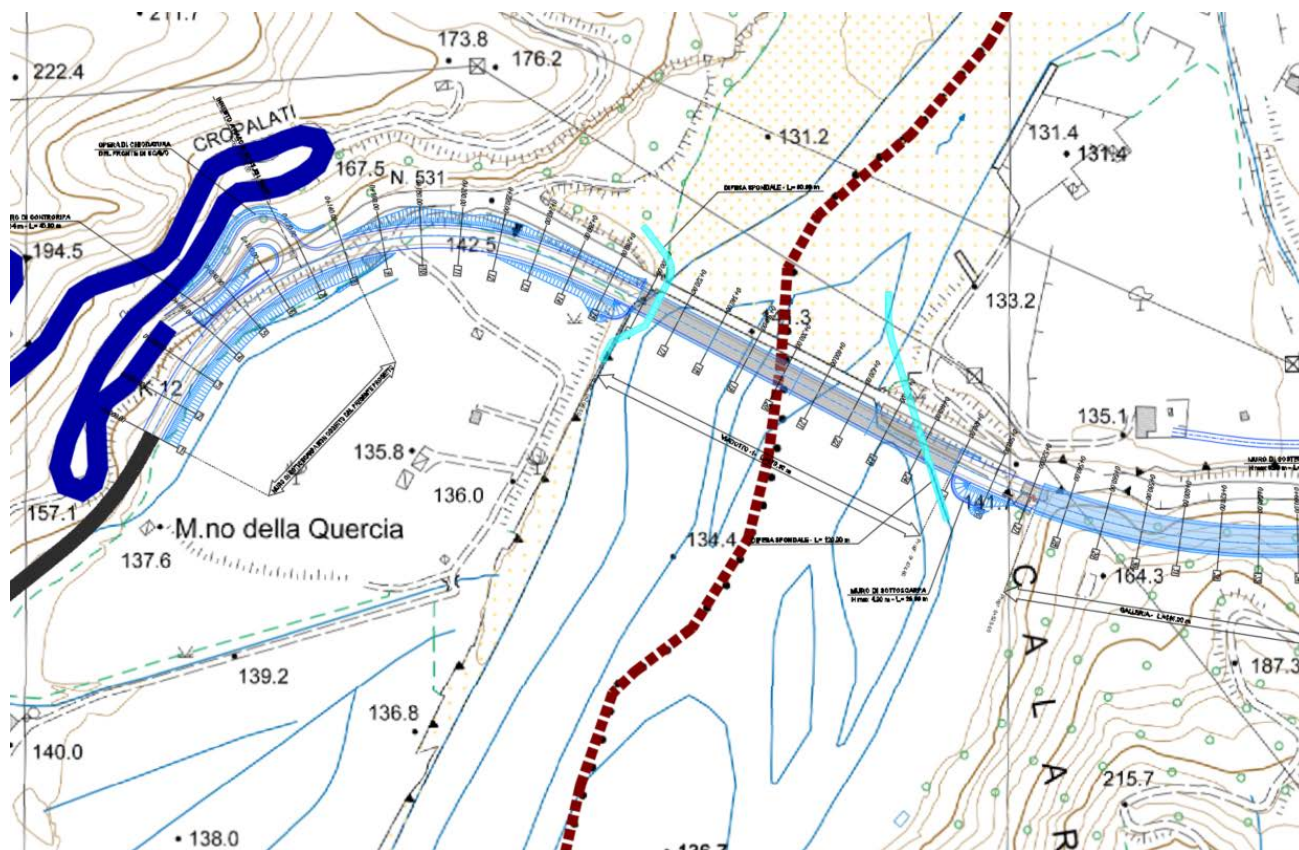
Inizio progetto a spalla riva dx ponte Trionto
